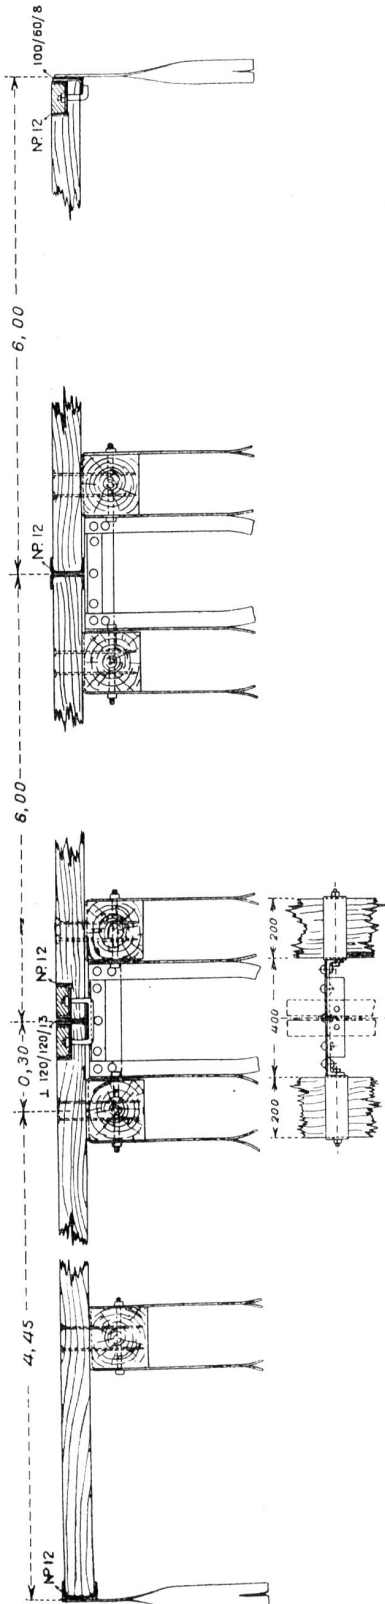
Abfallboden. Details der Befestigungen des Bohlenbelags. Schnitt parallel zur Flussrichtung. Maßstab 1 : 25.
